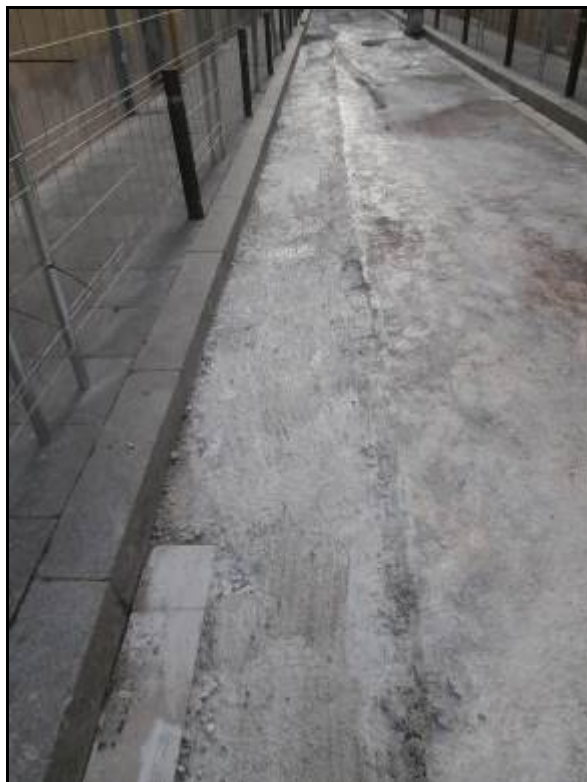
Trencament del paviment al carrer de Tagamanent.
